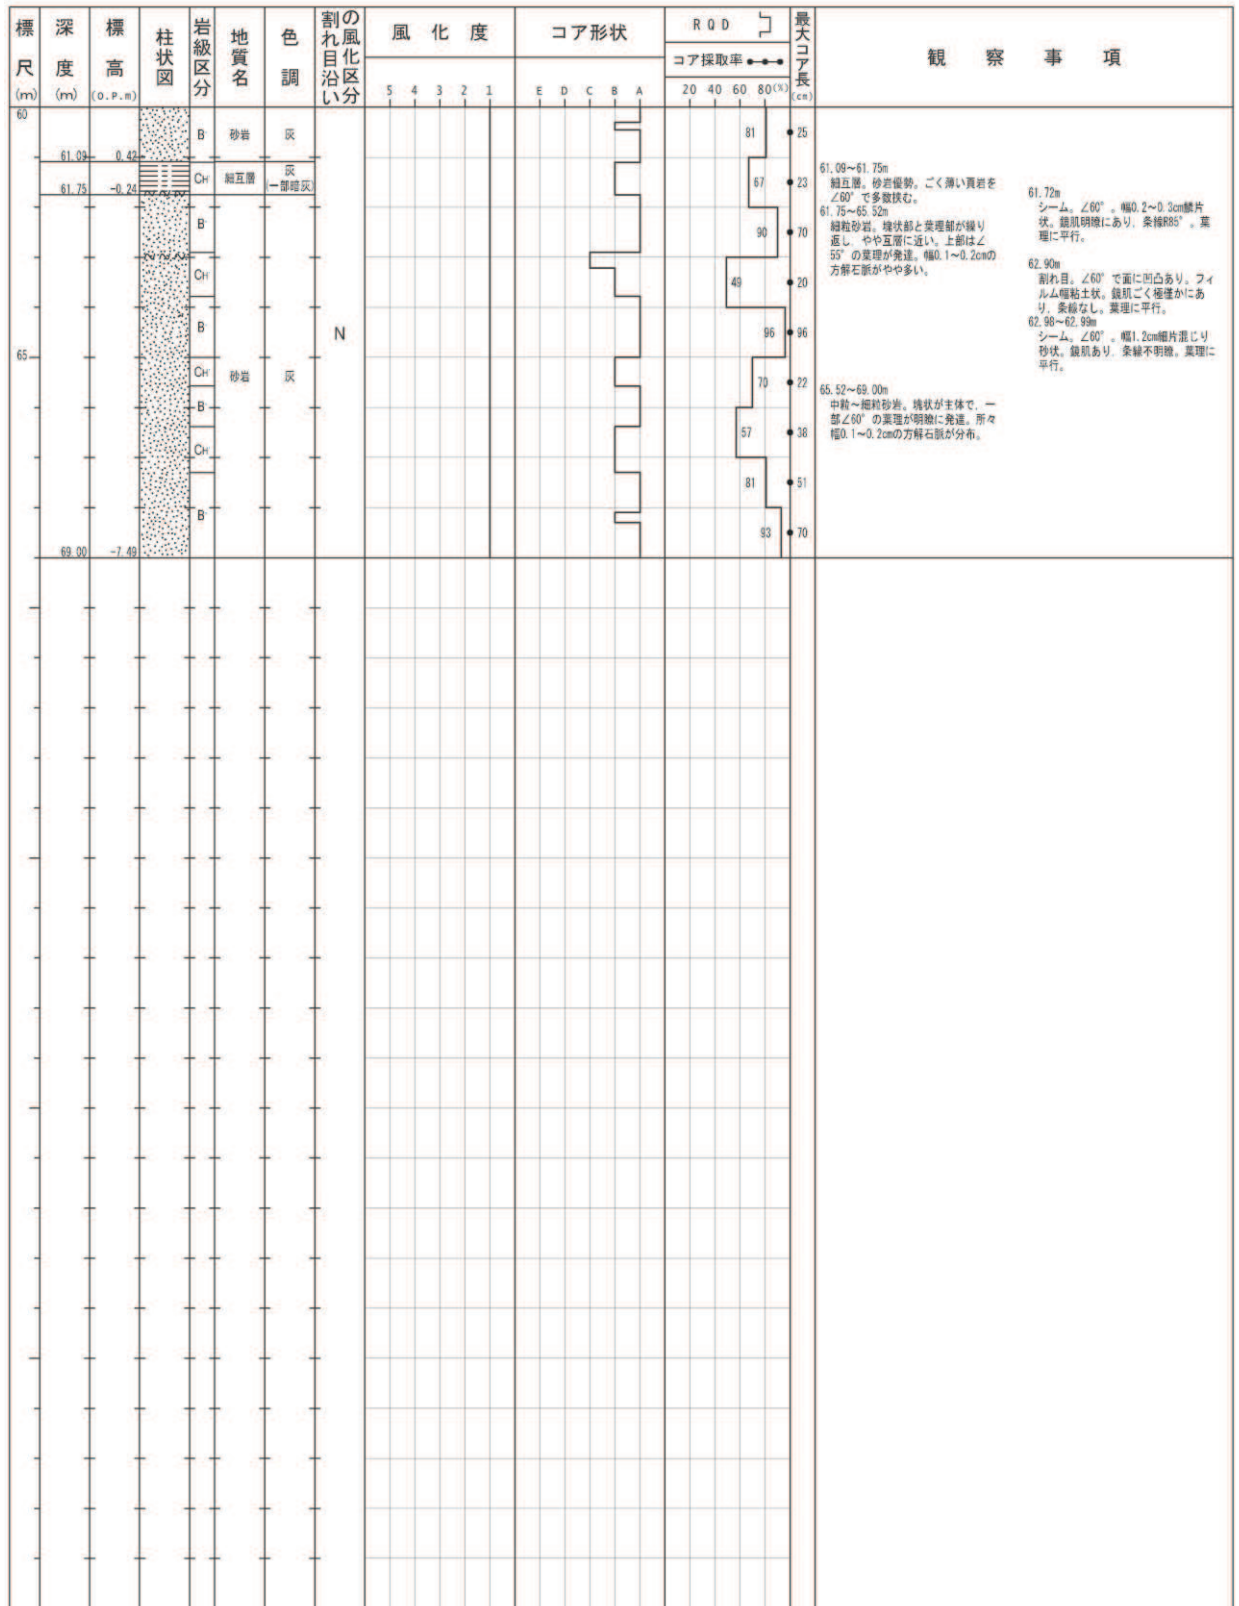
(5) ボーリング柱状図 (27SAB-1) (深度 60~69m)
